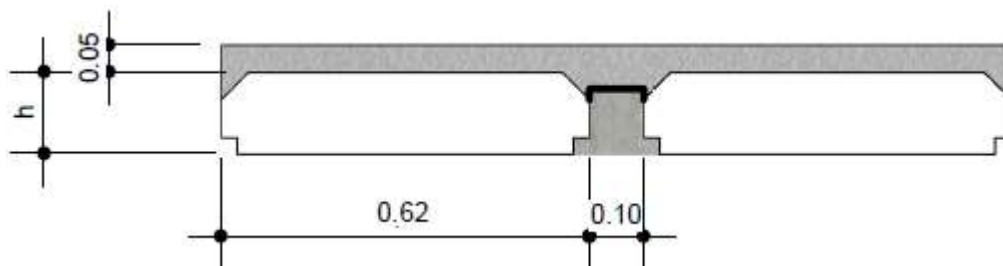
Sección tipo Viga-Bovedilla-Capa de hormigón
